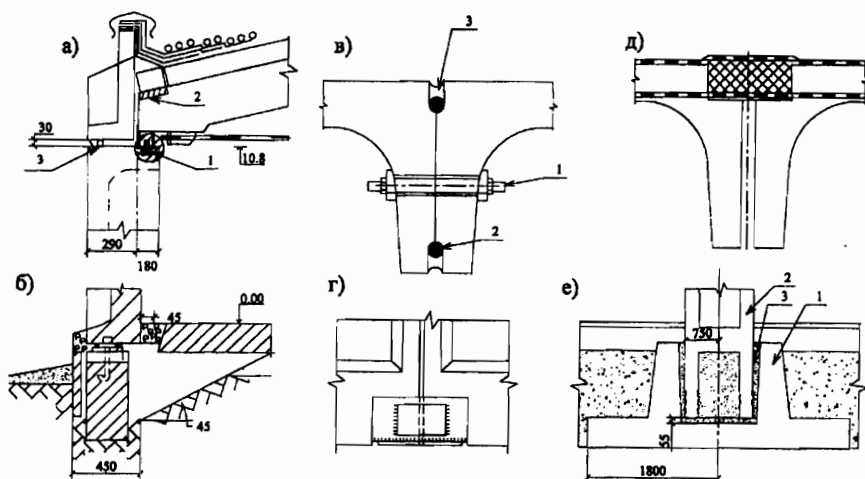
Узлы и соединения элементов быстромонтируемых зданий: а - узел соединения панели покрытия и фризовой панели с наружной стеновой панелью: 1 - фиксатор; 2 - свариваемые закладные детали фризовой панели и панели покрытия; 3 - гермитовый шнур; б - соединение наружной панели с элементом фундамента: 1 - закладная деталь; 2 - болтовое соединение; в - соединение панелей наружных стен: 1 - стяжной болт; 2 - гермитовые шнуры; 3 - расшивка шва цементно-песчаным раствором; г - соединение наружных панелей сварными накладками; д - термовкладыш стыка панелей покрытия с гидроизоляцией; е - схема размещения колонны в стакане фундамента: 1 - фундамент; 2 - колонна; 3 - омоноличивание стыка
